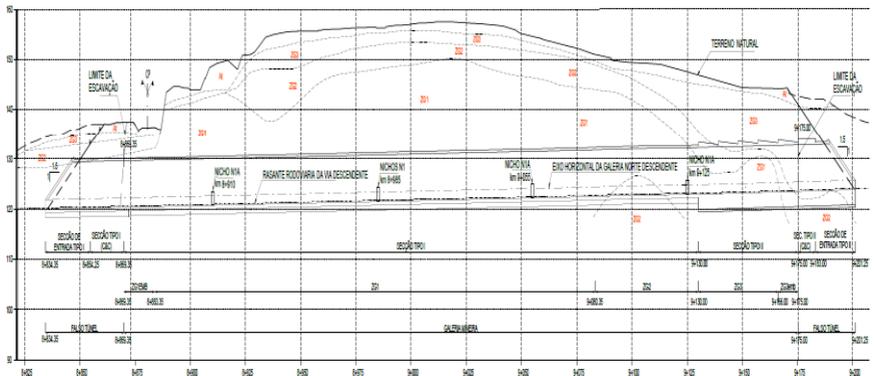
Perfil longitudinal geológico – geotécnico (Fonte: Projeto de construção)
